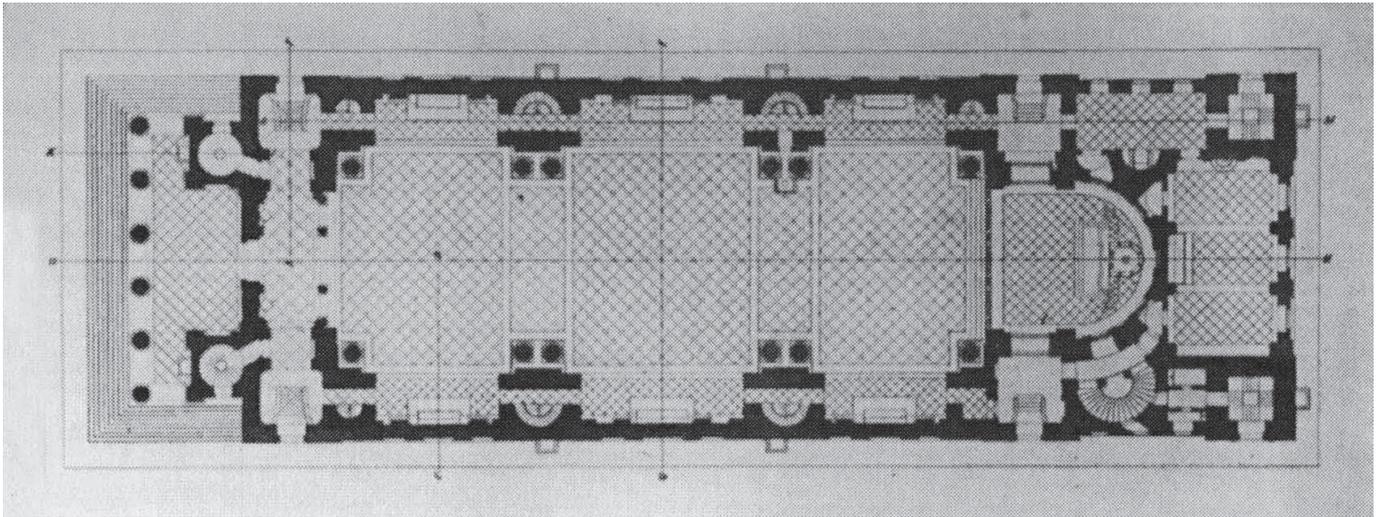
Pietro Nobile, pianta della chiesa (1823).
